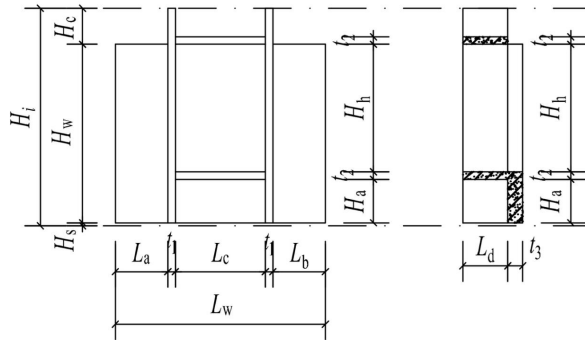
混凝土预制飘窗尺寸示意图
